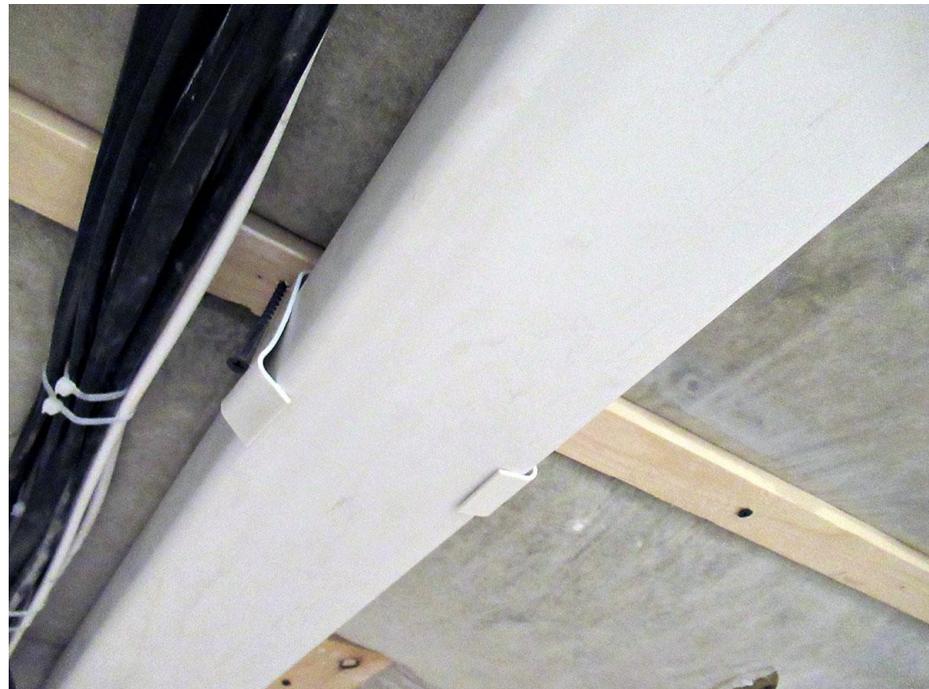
Смонтированная системы вентиляции не закреплена надлежащим образом, фасонные элементы и воздуховоды системы вентиляции смонтированы между собой на бумажный скотч
